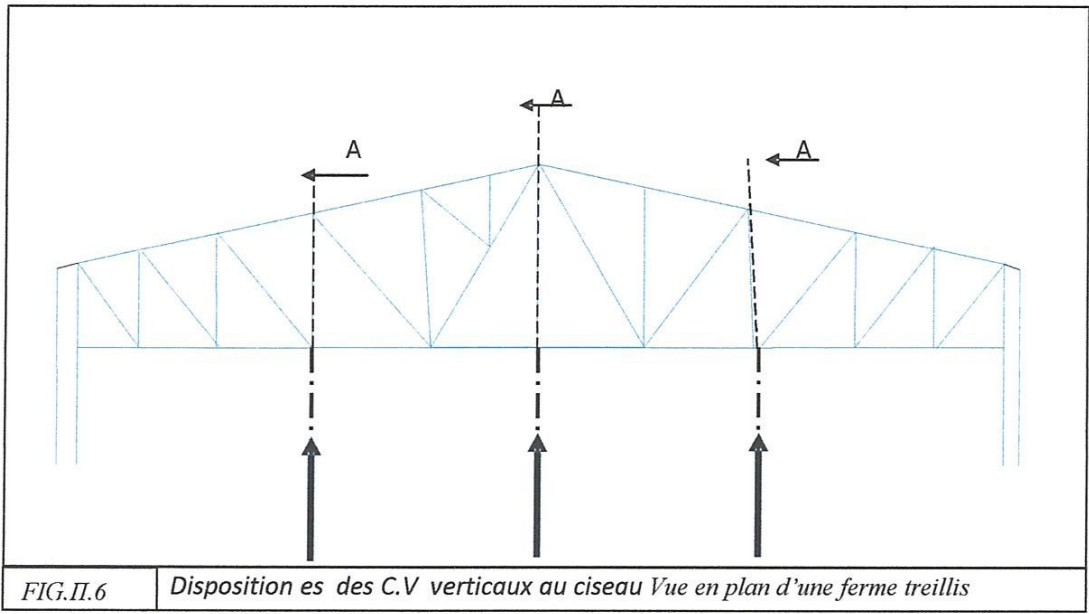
Disposition es des C.V verticaux au ciseau Vue en plan d'une ferme treillis
